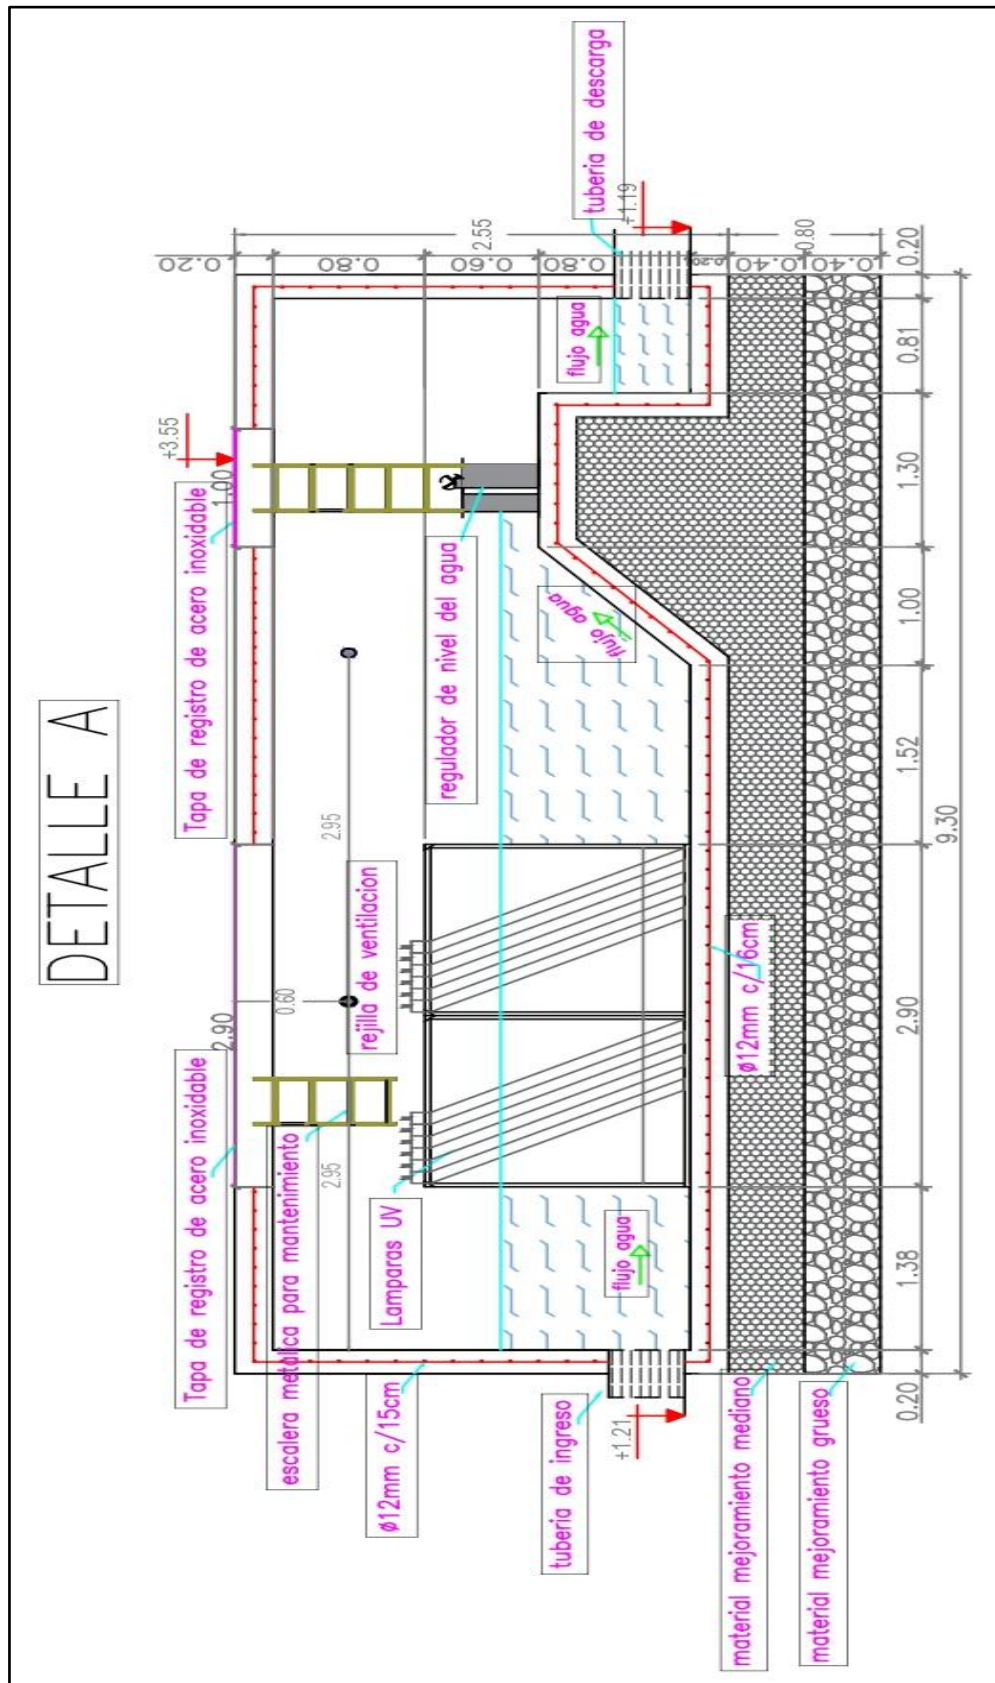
Detalle A (corte longitudinal) cisterna para equipo de desinfección
